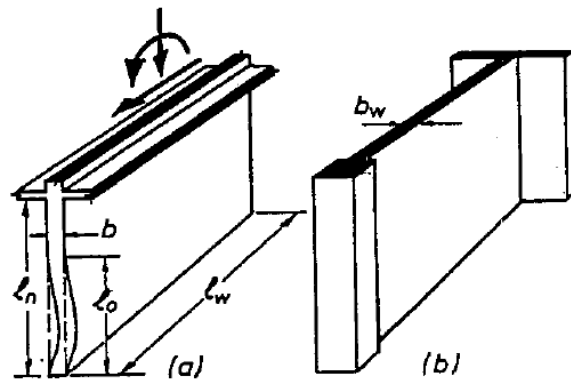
Configuración típica de un muro estructural, adaptado de [6].
